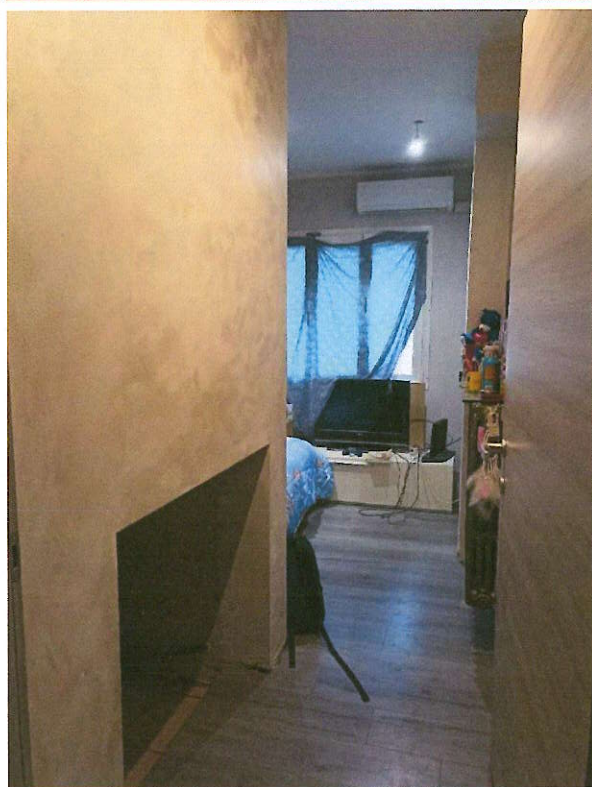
Il corridoio d'accesso e la camera ricavata dietro l'angolo cottura.
